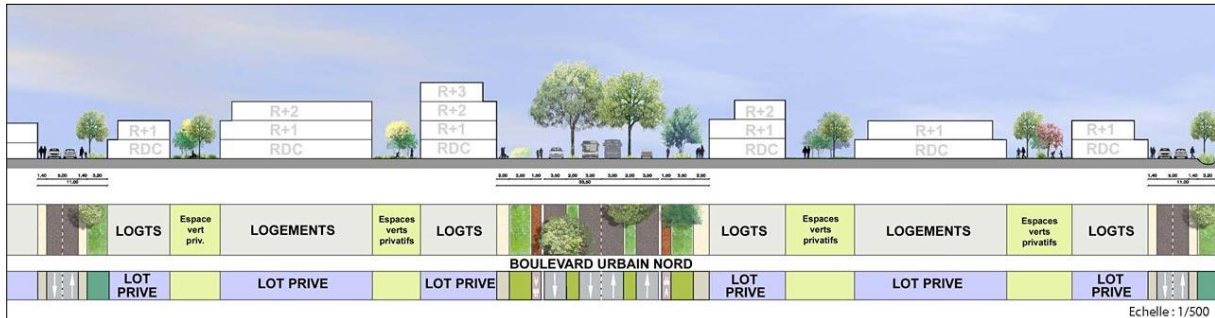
(2.2): Profil à travers d'un boulevard urbain.
